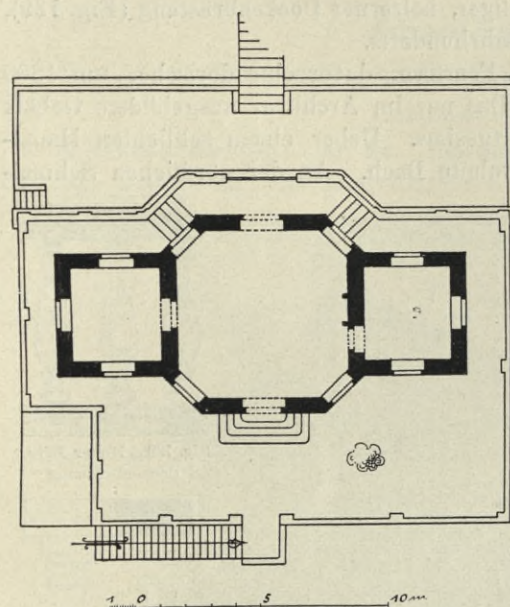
Niederlössnitz, Friedstein, Grundriss.
